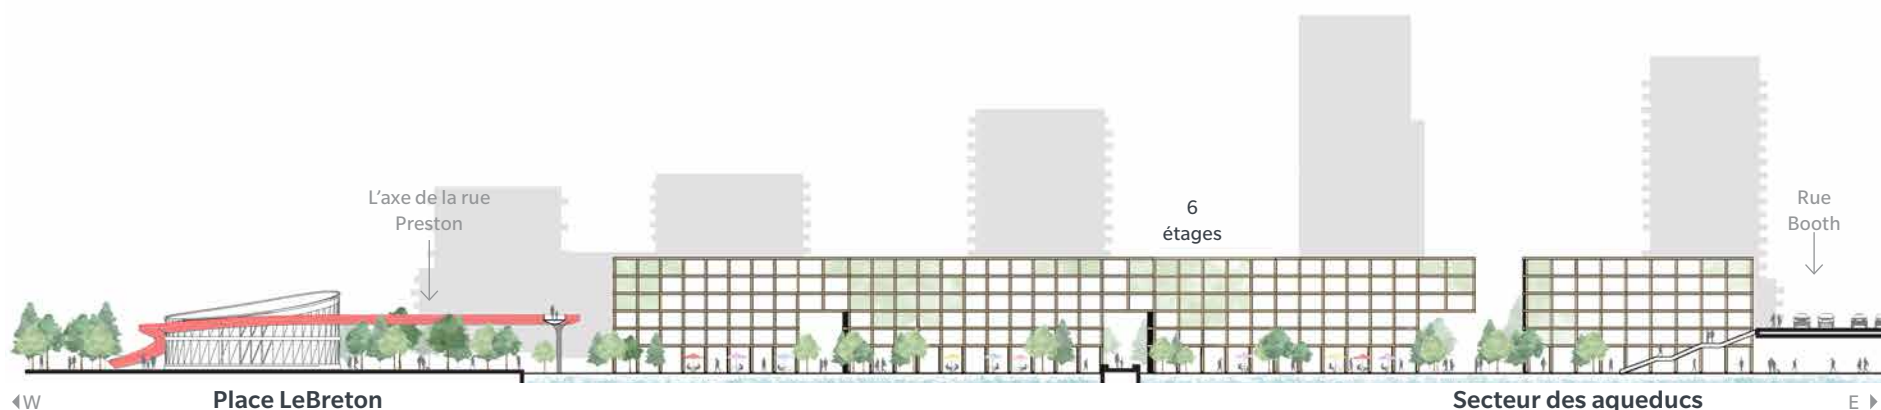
Dessin en élévation (d'ouest en est) illustrant le raccordement de l'axe de la rue Preston et le secteur des aqueducs.
